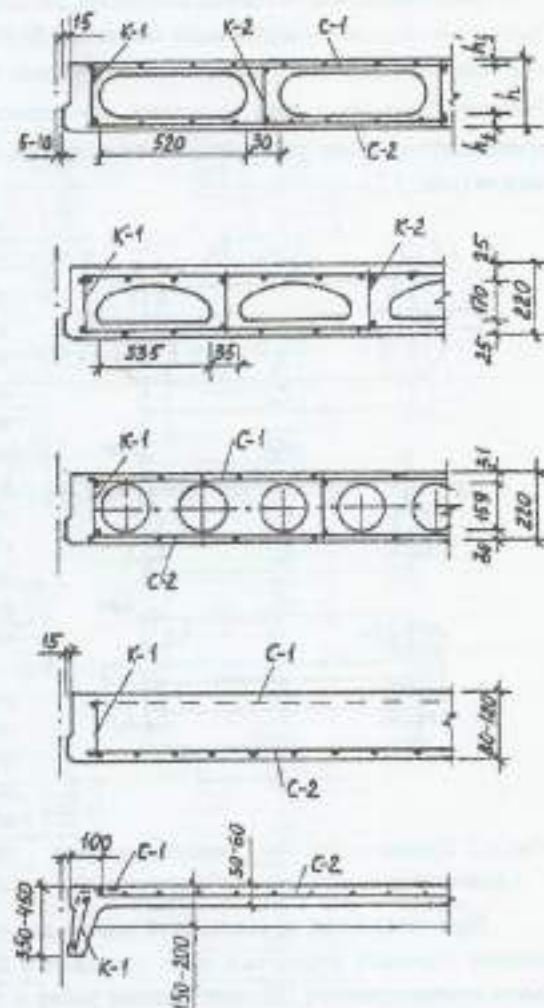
Типы поперечного сечения плит перекрытия и их армирование
